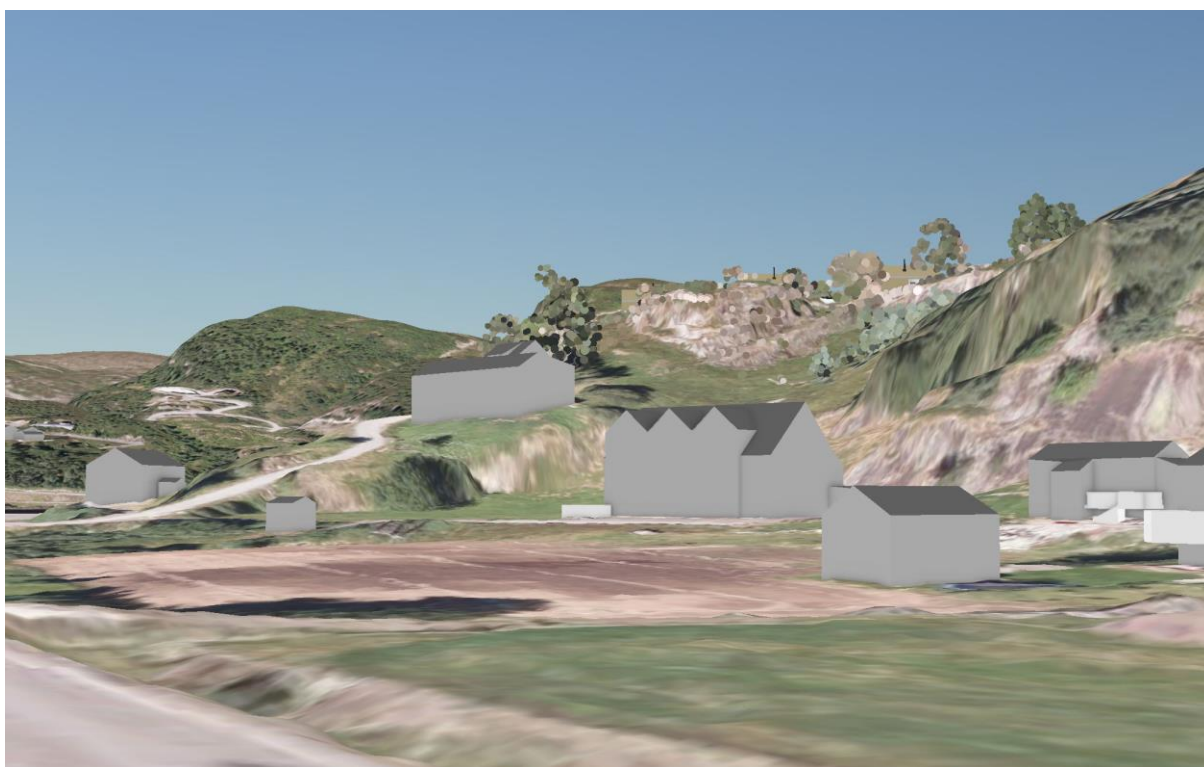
Planlagt bebyggelse sett fra fylkesveien øst for planområdet
